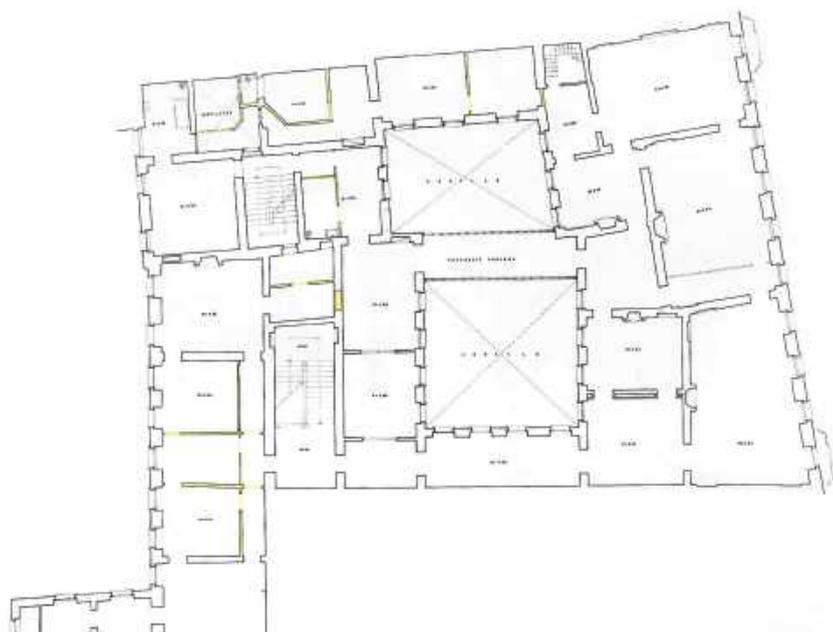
Pianta piano primo (sede del museo), prima dei lavori di restauro (rielaborazione)
